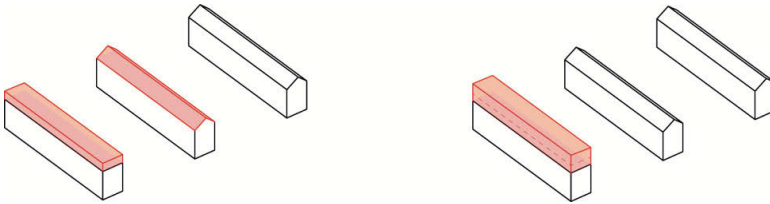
Piktogramme Dachgeschossausbau – Aufstockung
